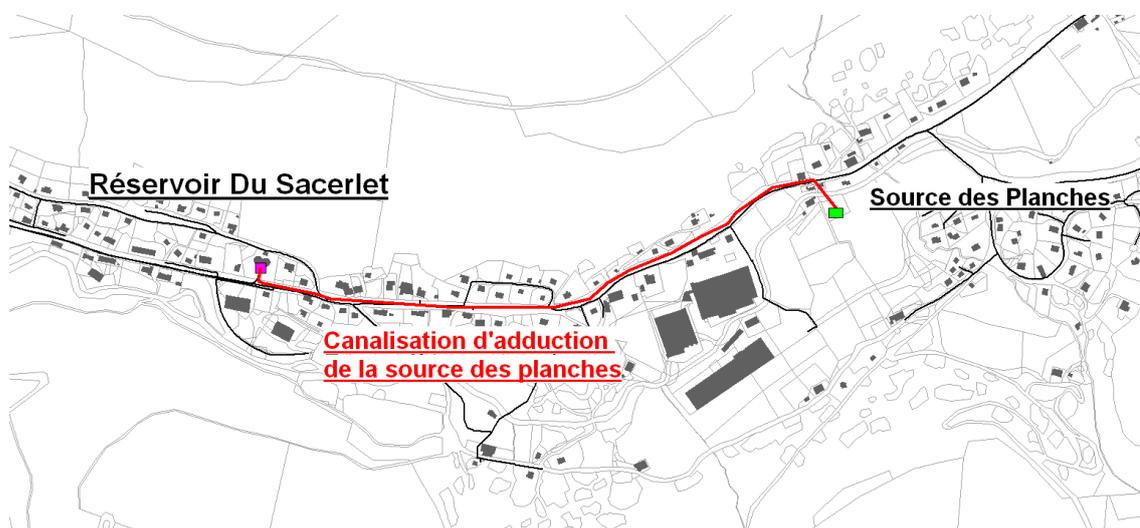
Plan de Localisation de la canalisation de la source des planches
